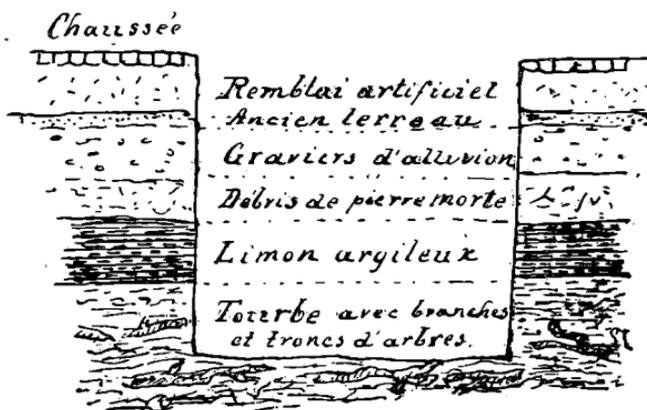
Coupe de la tranchée de la correction du Bied, au Locle.
